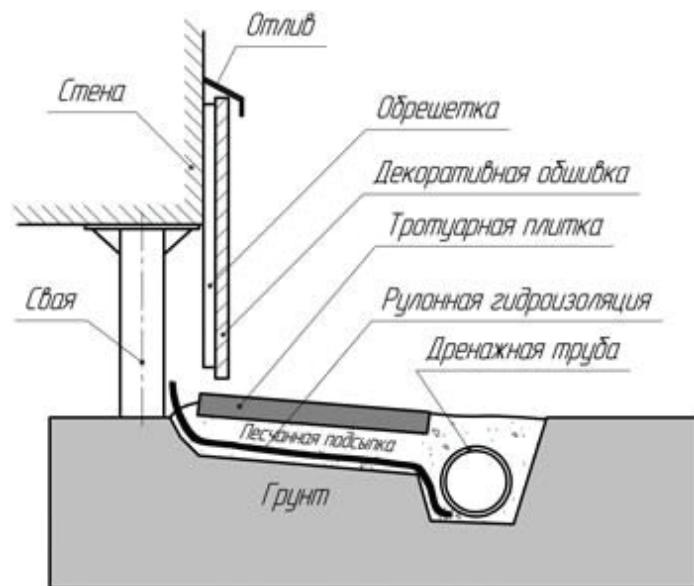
Отделка свайного фундамента цокольным сайдингом
